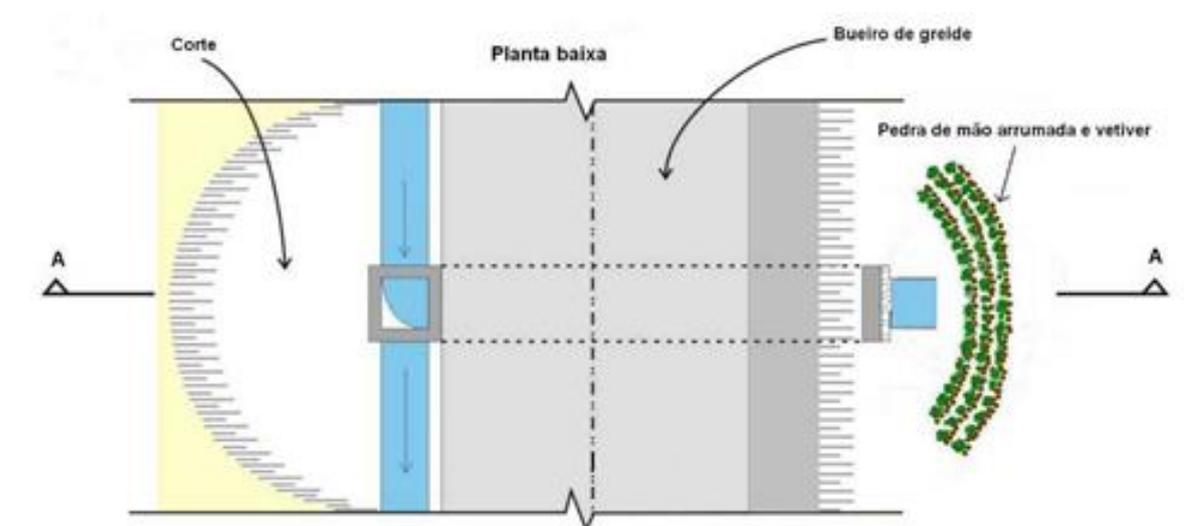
Desenho esquemático para a proteção de saídas de bueiros (corte transversal – sem escala) (Fonte: Elaboração própria)
